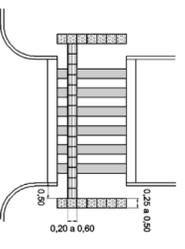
Faixa elevada com sinalização tátil de alerta e direcional
